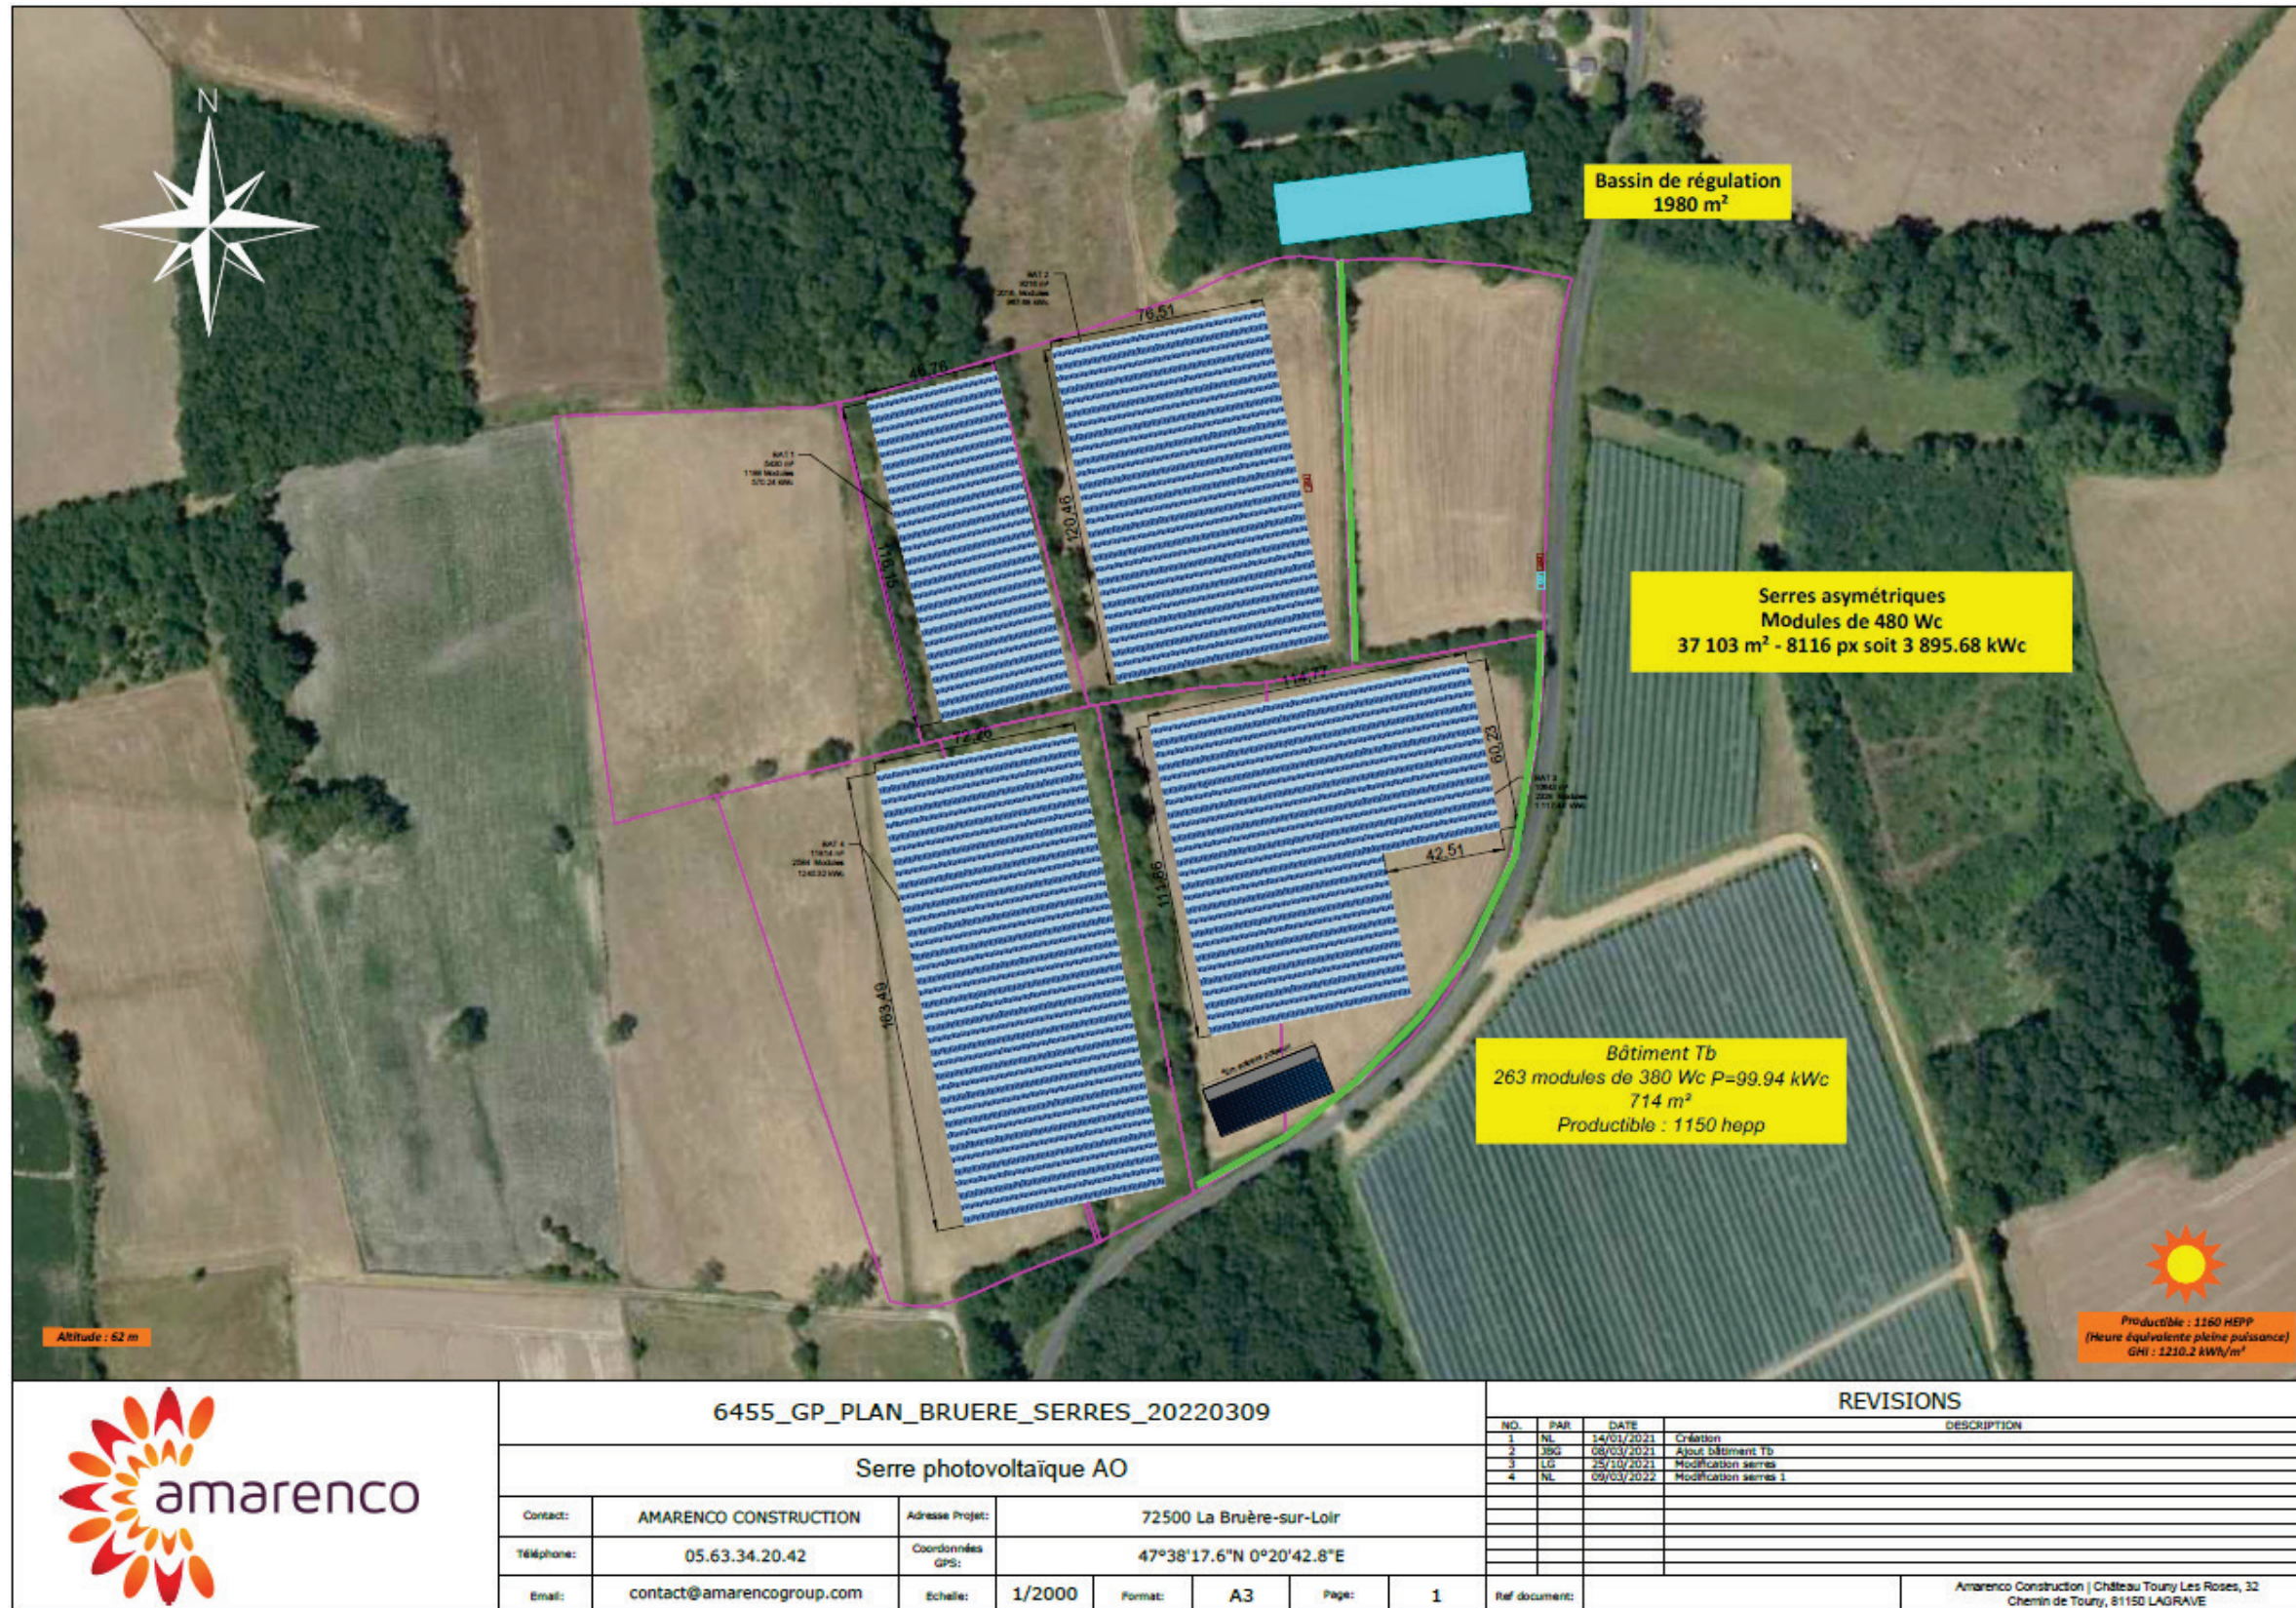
Plan d'implantation (Source : AMARENCO, Avril 2022)
